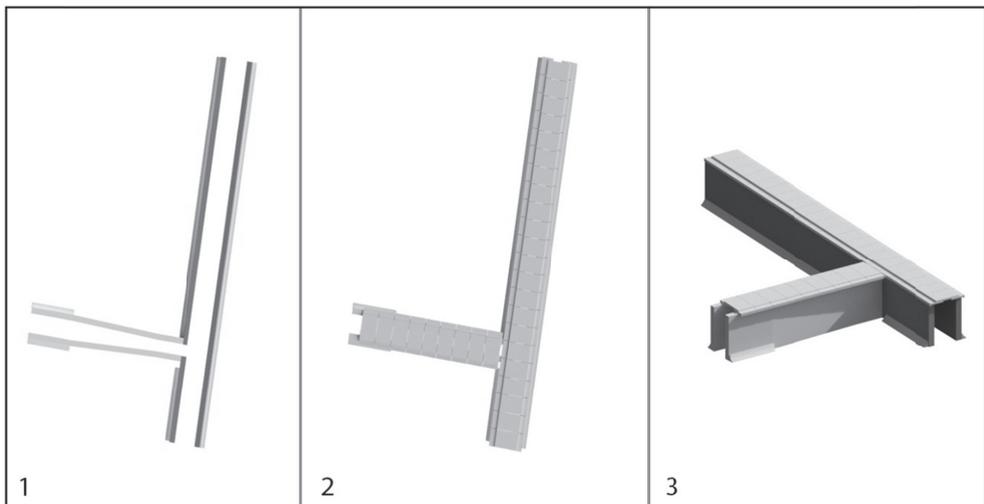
Renderizado del canal romano C-101 y C-102. Las figuras 1 y 2 muestran la planta del canal sin y con el recubrimiento por tejas respectivamente. Se aprecia un leve estrechamiento en la conexión del canal C-102 con el C-101 así como la pérdida de moldura de media caña. La figura 3 es una visión ortográfica del mismo.
